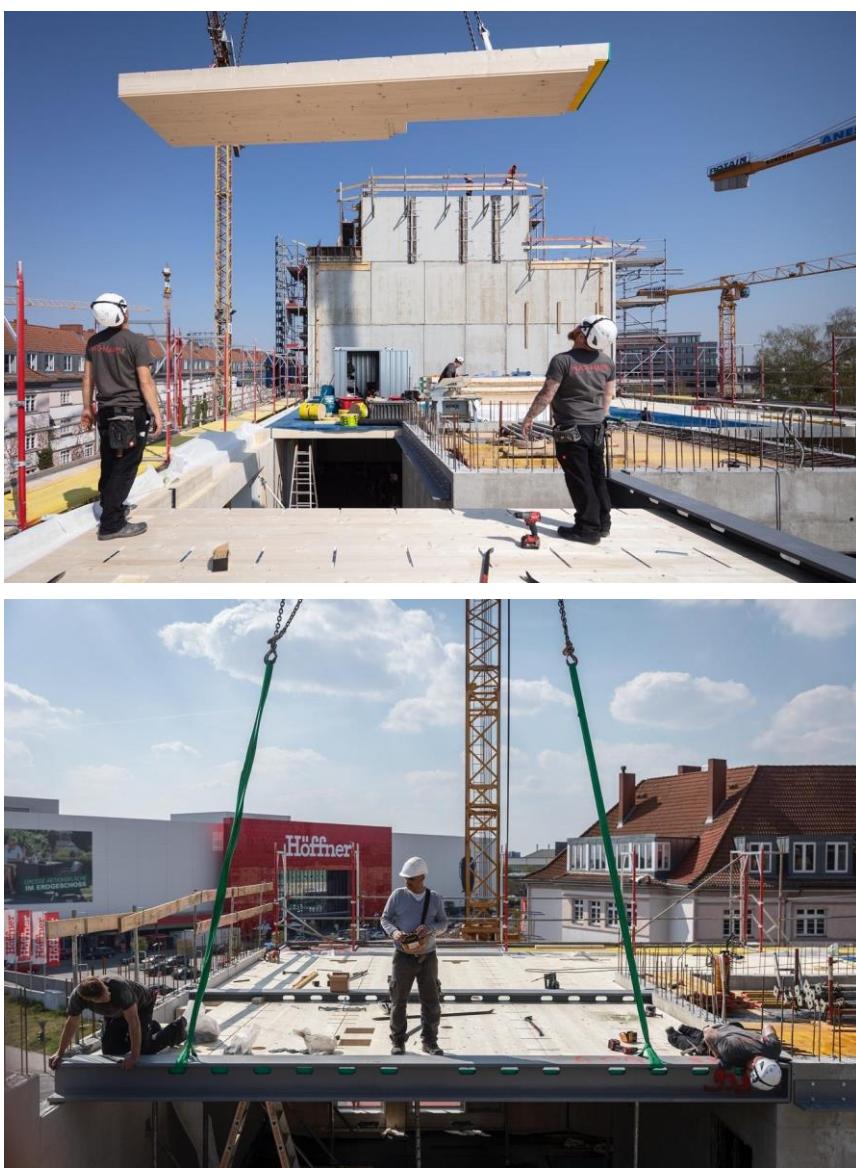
, 15: Baustelle Gotenstraße 44, Berlin Schöneberg – Fotos: Andreas Meichsner, Berlin
